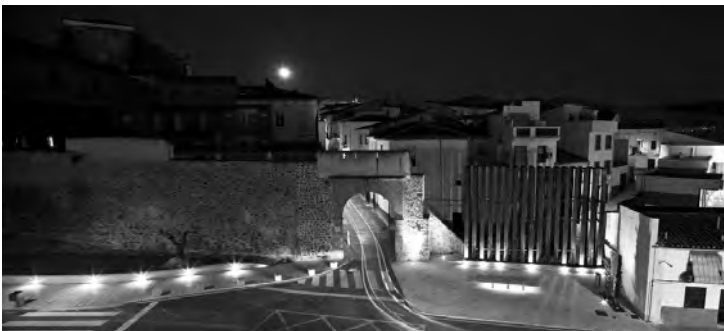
Rubiolo. Muralla junto a la puerta de Coria. Después de la actuación. Foto Subliminal.
